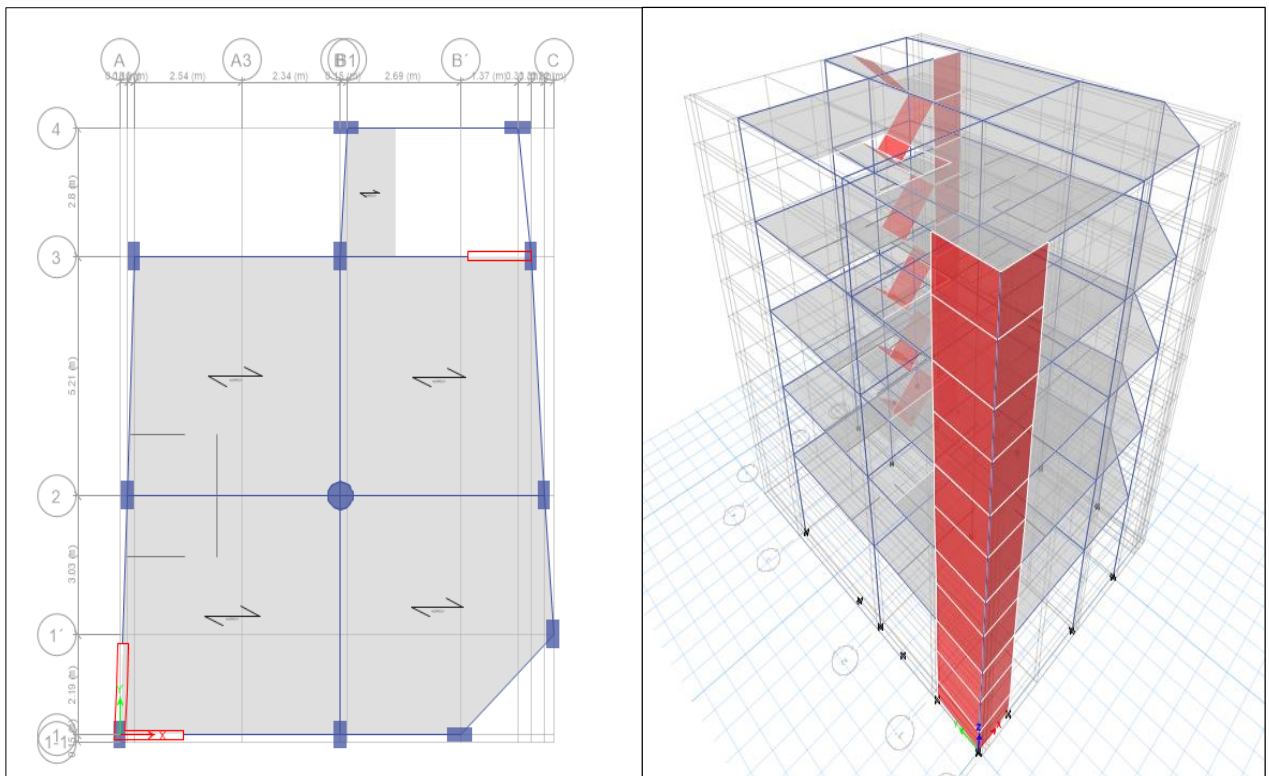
Modelamiento de la estructura con placas, vista en planta, vista en 3D, fuente programa ETABS.
